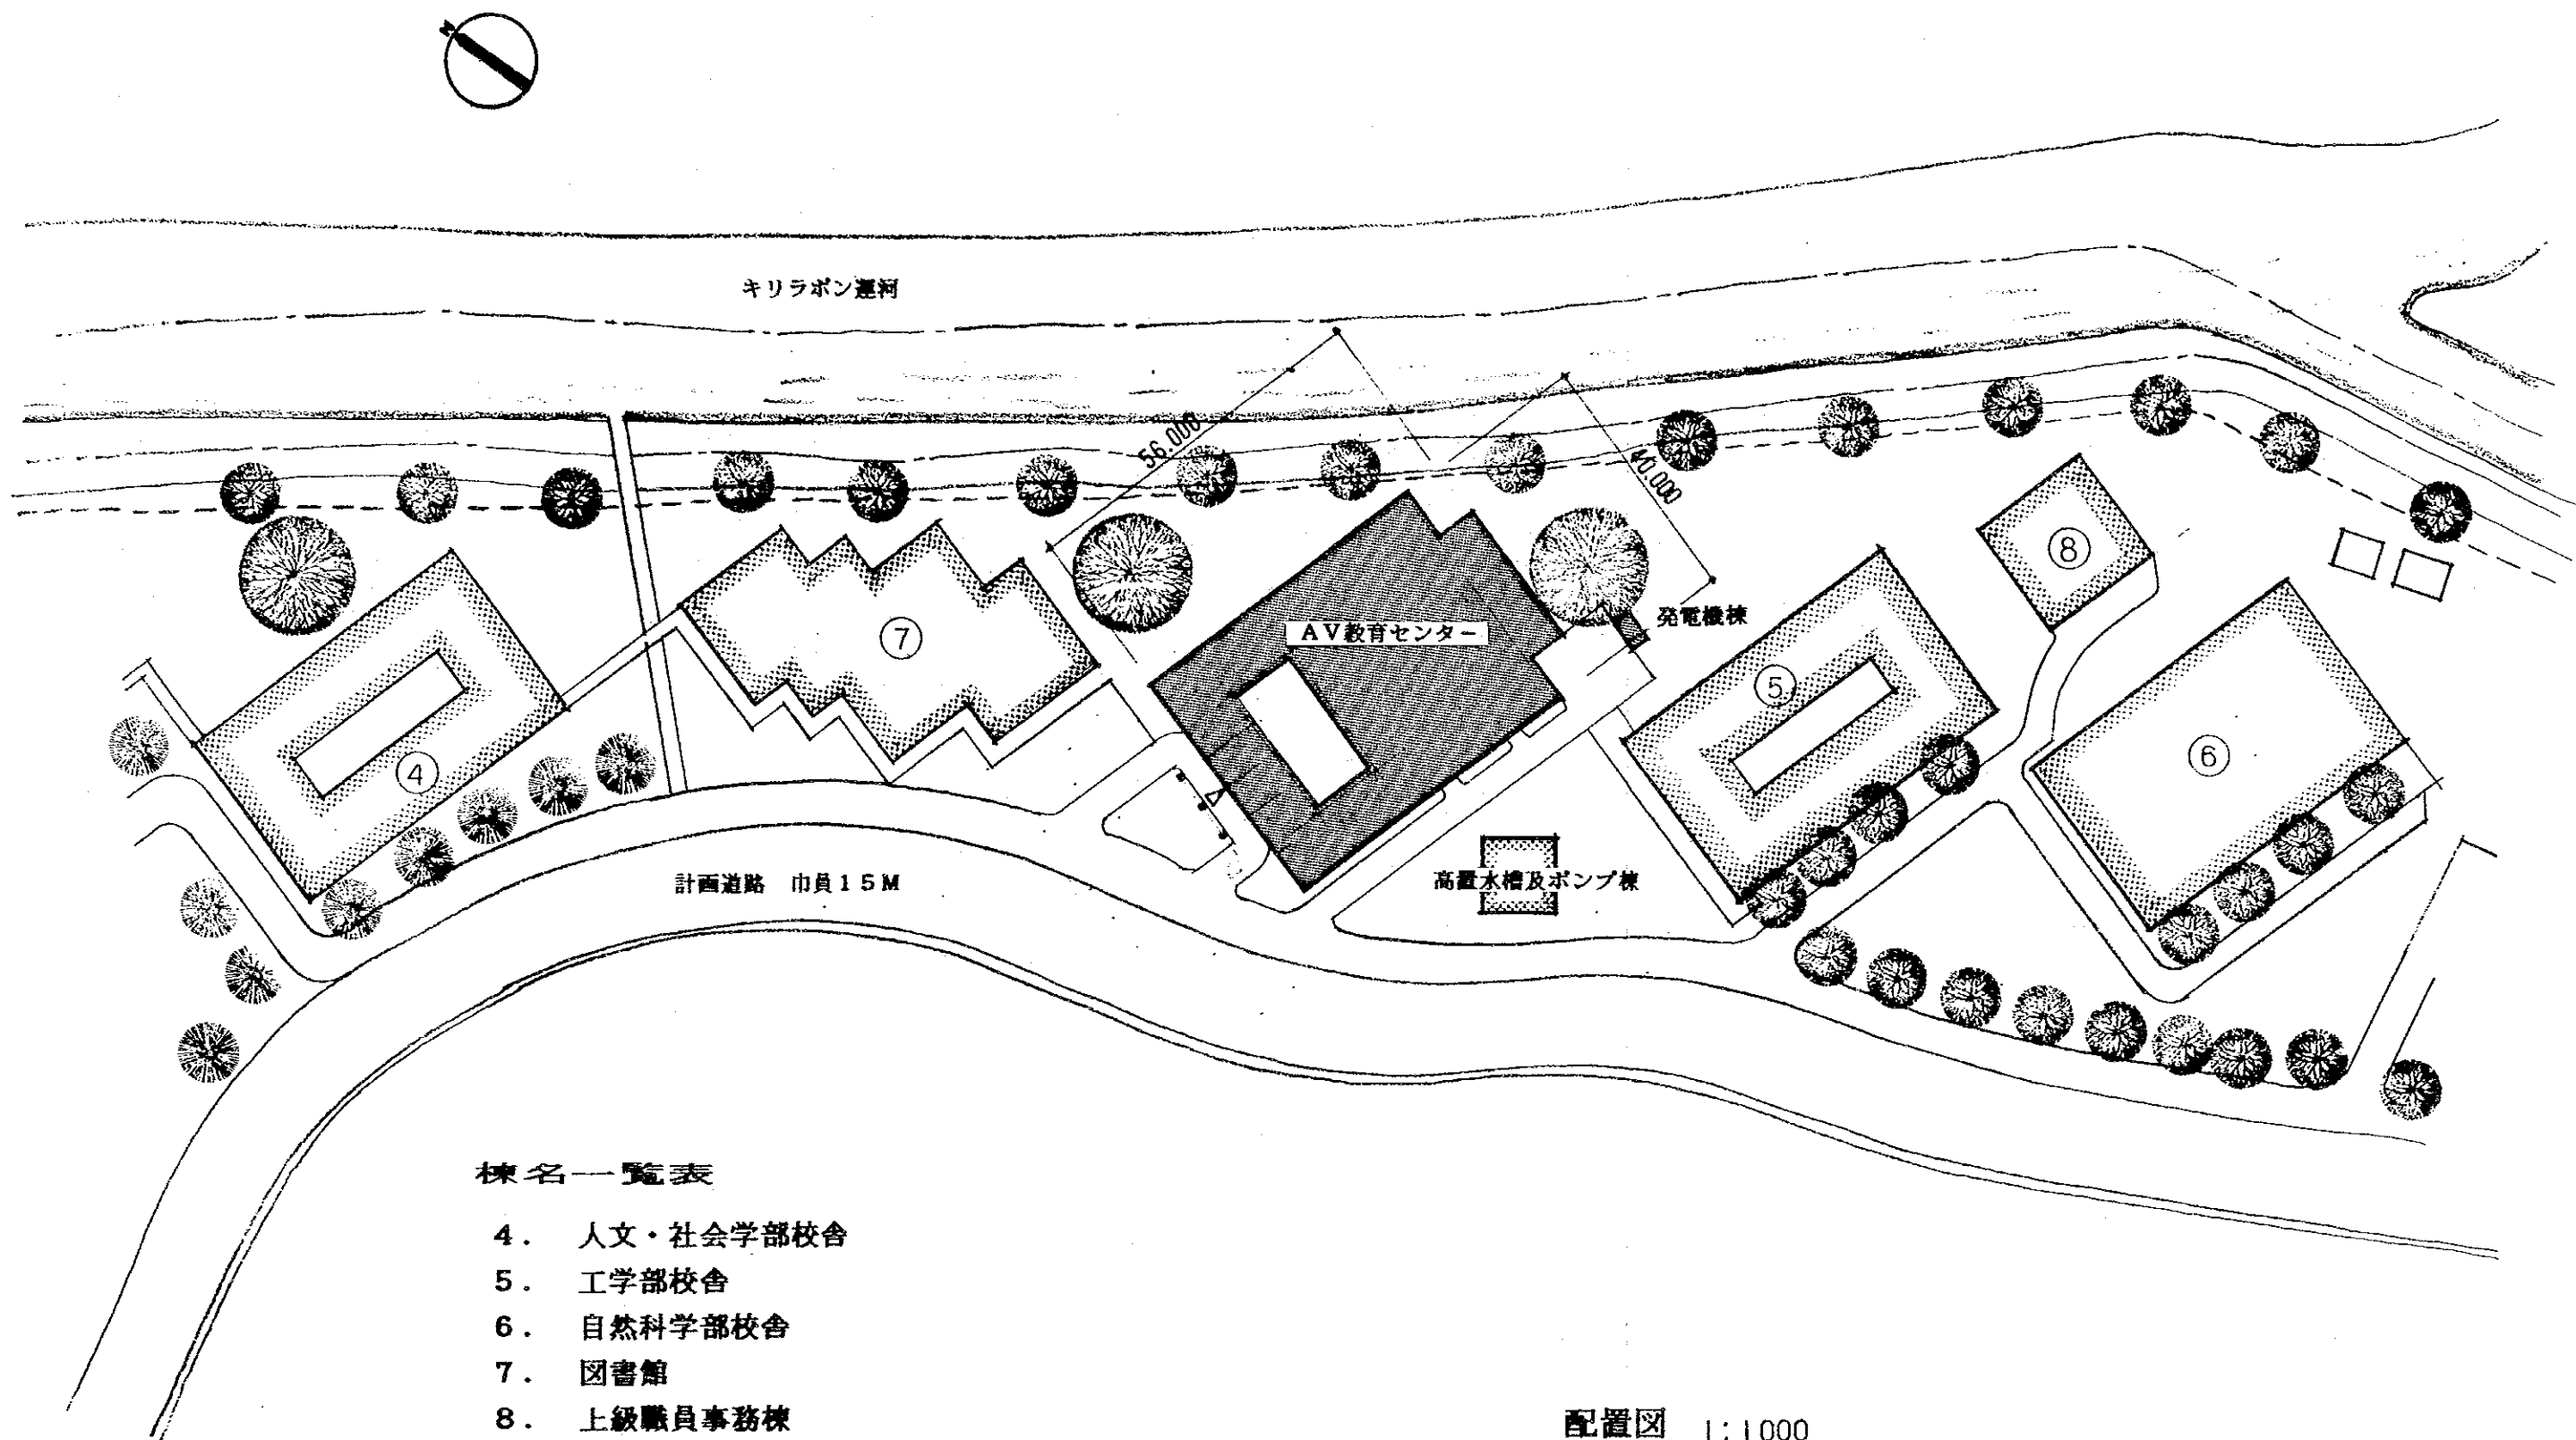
スリランカ公開大学AV教育センター配置図 1:1,000
